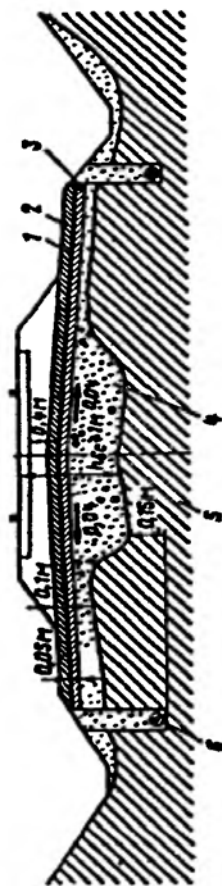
Схема конструкции гидроизоляционного покрытия при общей толщине балластного слоя $h_{бс} > 1$ м: 1 — гидроизоляция; 2, 3 — верхний и нижний защитные слои; 4 — невырезанная часть старого балласта; 5 — глинистые грунты; 6 — дренаж мелкого заложения
